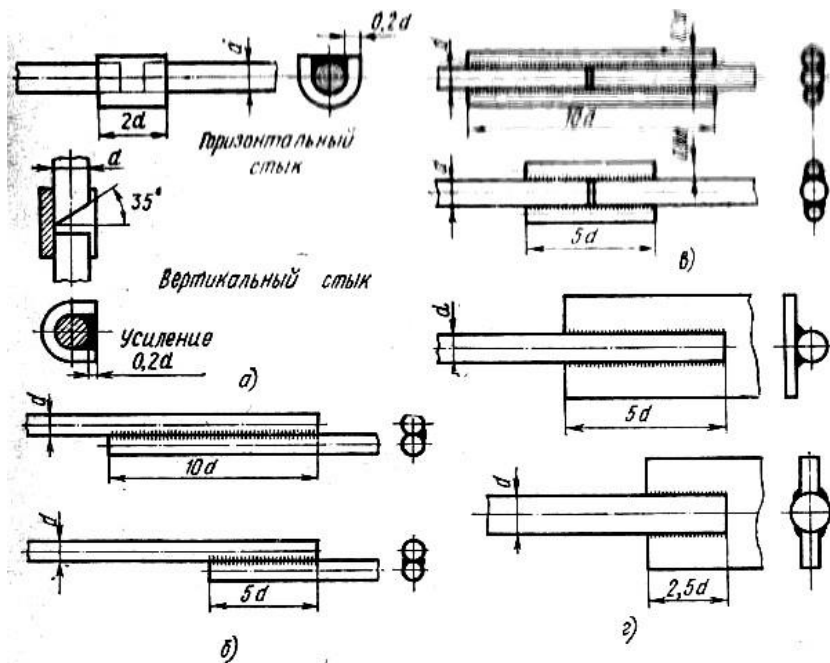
Способи з'єднання зварний арматури залізобетону: а – стикові, б – внакладку, в – з круглими накладками, г – з плоскими елементами
